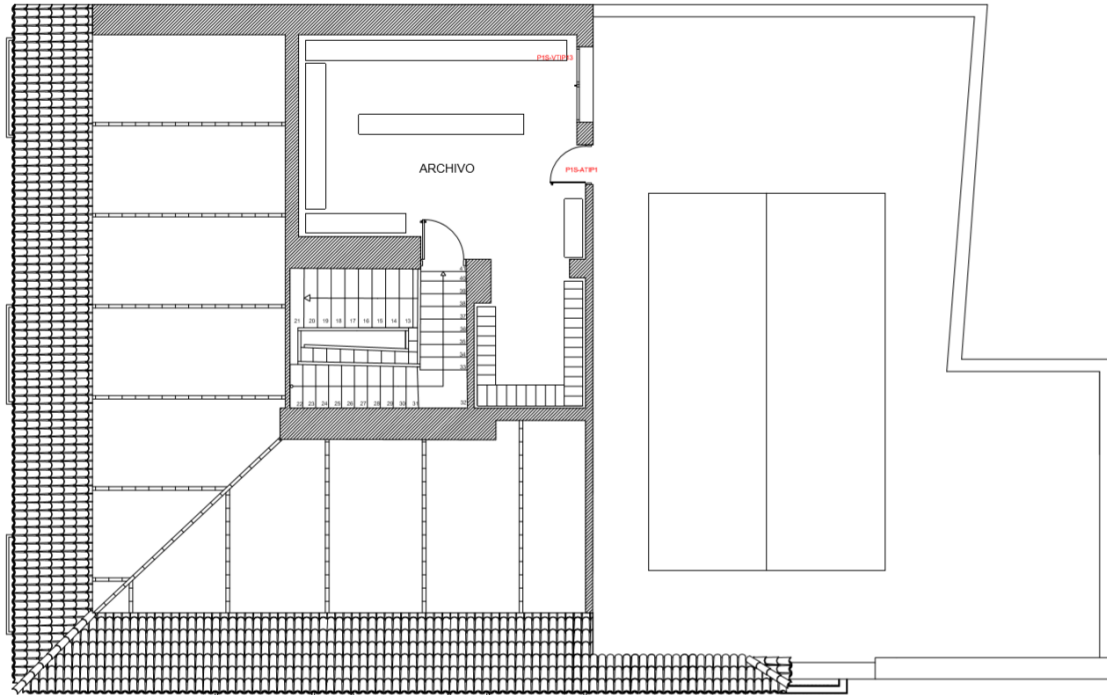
Plano planta segunda. Estado actual 2019. Fuente: Elaboración propia, creación 21/06/2019
